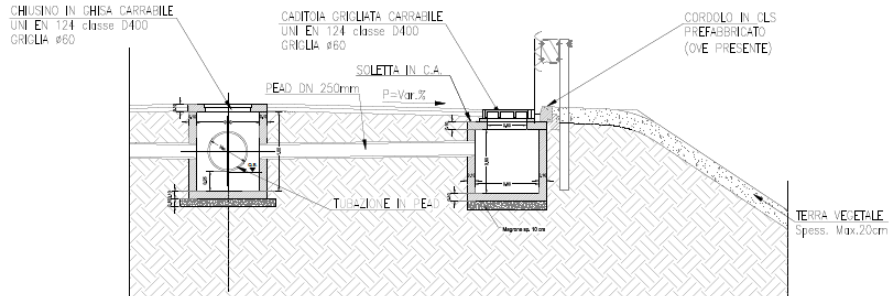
Sezione trasversale e pianta del sistema di drenaggio NV090 TRATTO II a Sud
